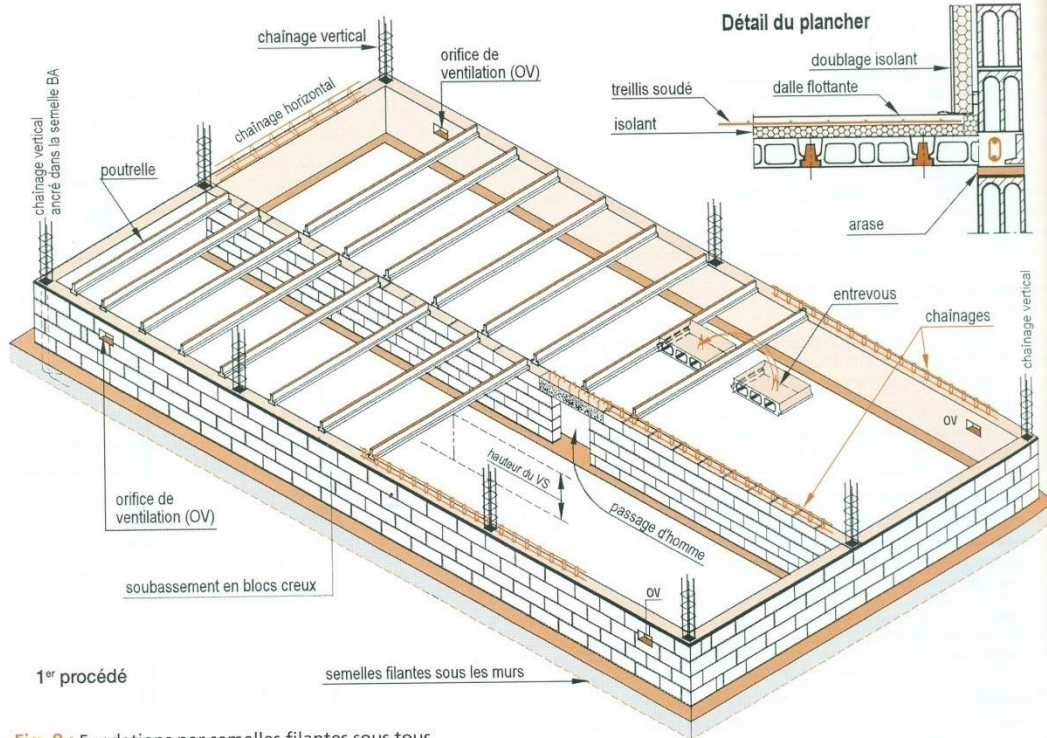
Fondations par semelles filantes sous tous les murs extérieurs et de refend
